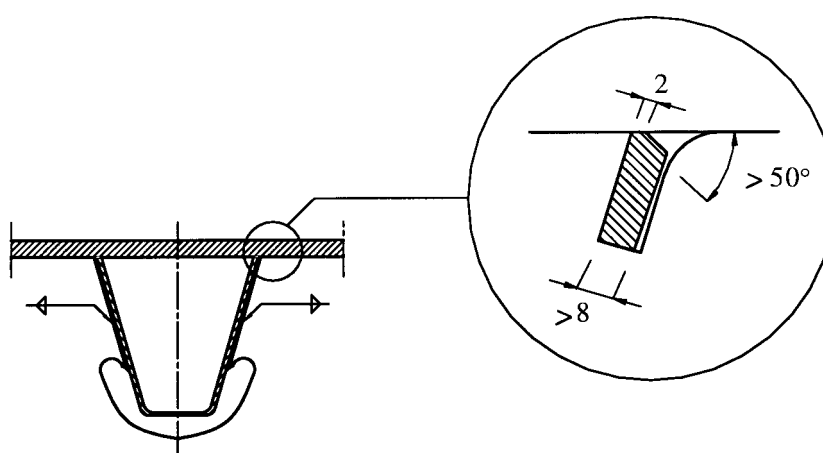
Préparation des soudures de l'assemblage raidisseur – tôle de platelage
